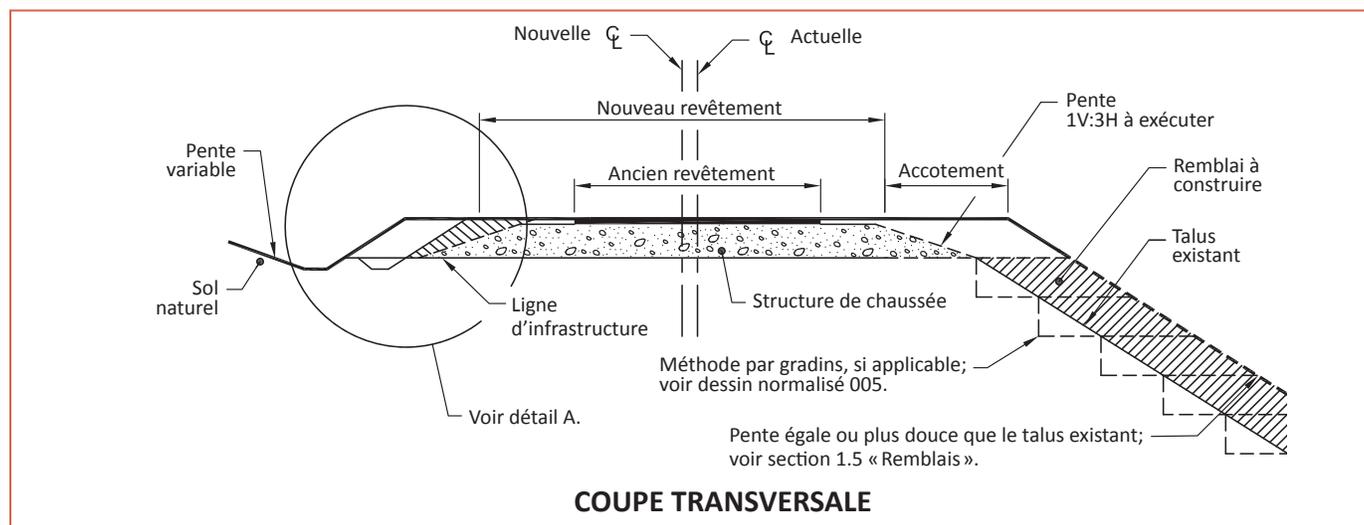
Extrait du DN-II-1 006 « Élargissement de chaussée, structure de chaussée existante conservée »
